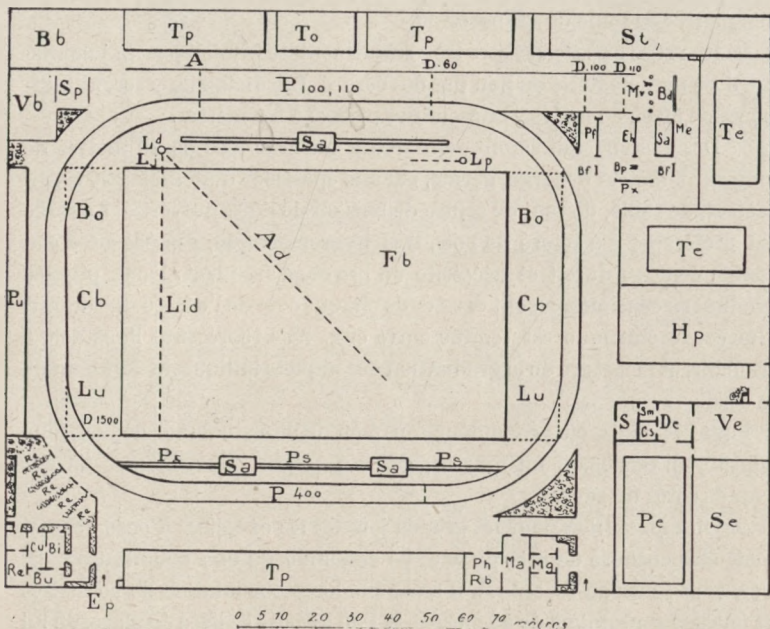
Plan d'un stade moderne de 200 m. x 150 m. (d'après de Bellefon).
